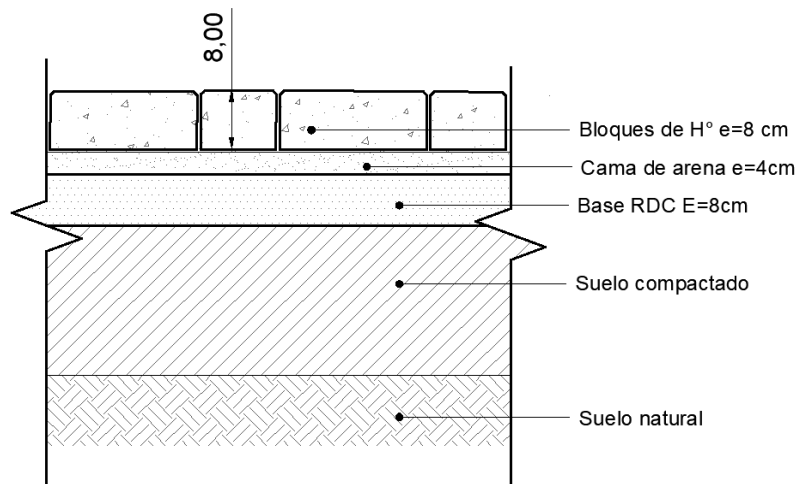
Paquete estructural de pavimento articulado. Fuente: Elaboración propia.
